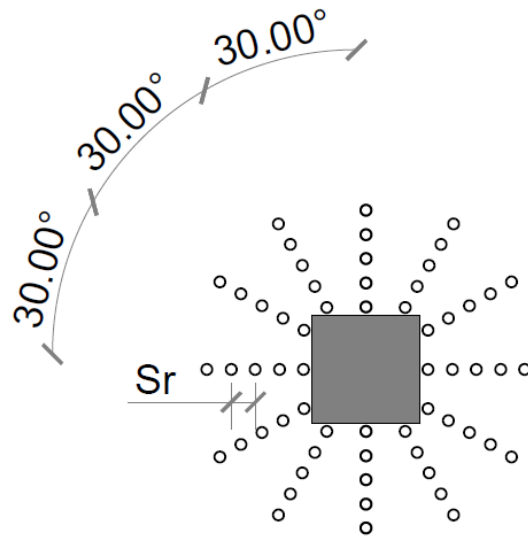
Detalhe da armadura de cisalhamento das lajes compostas por cinco camadas de *studs
